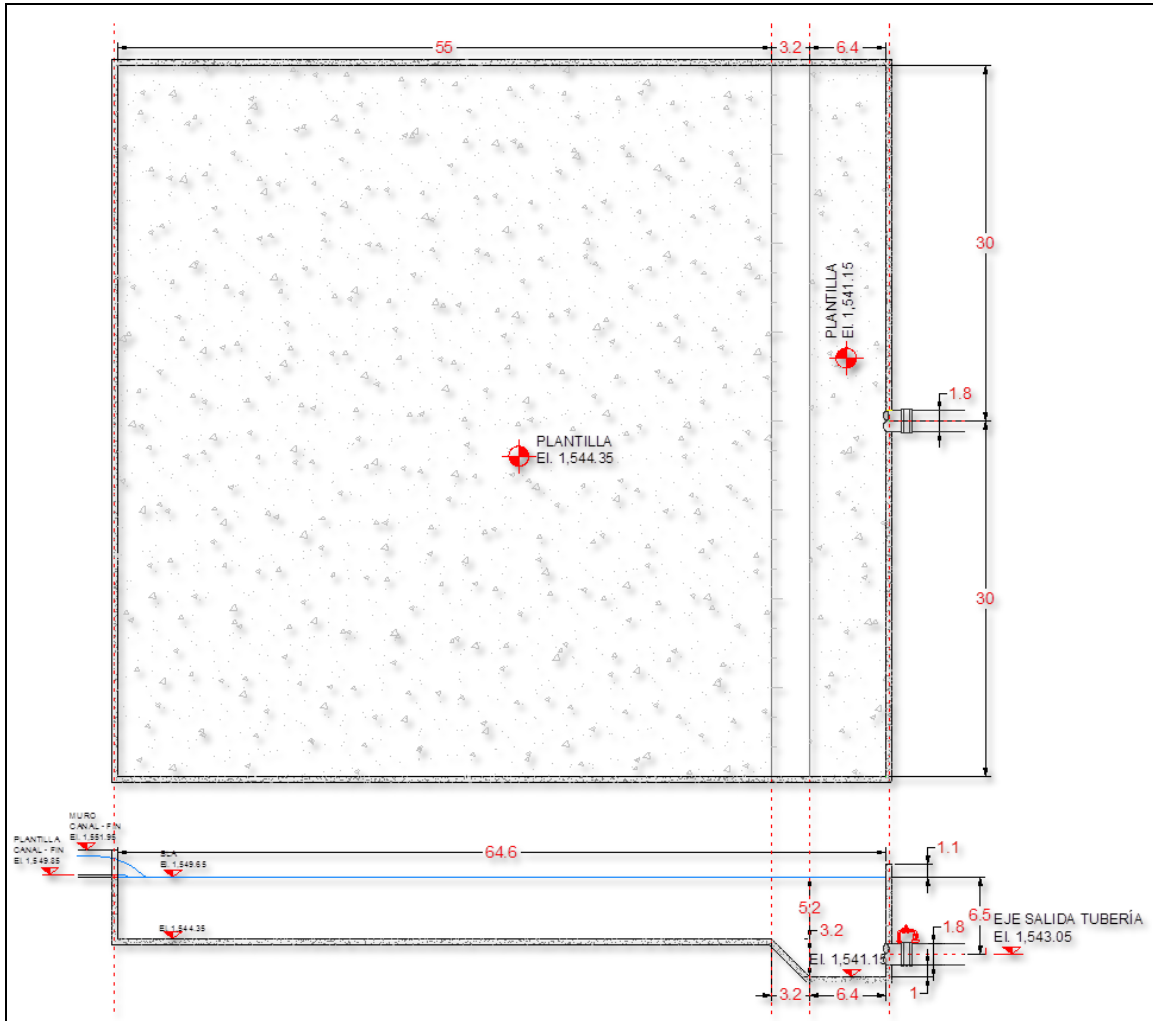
Vista en planta del tanque de carga. Dimensiones en cm
